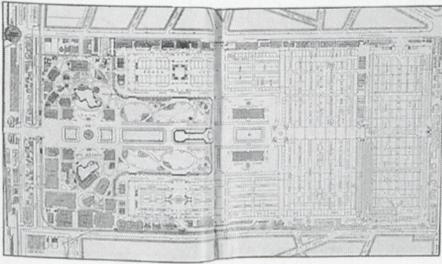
Weltausstellung 1889, Grundriss der Bauten und Pavillons auf dem Marsfeld
